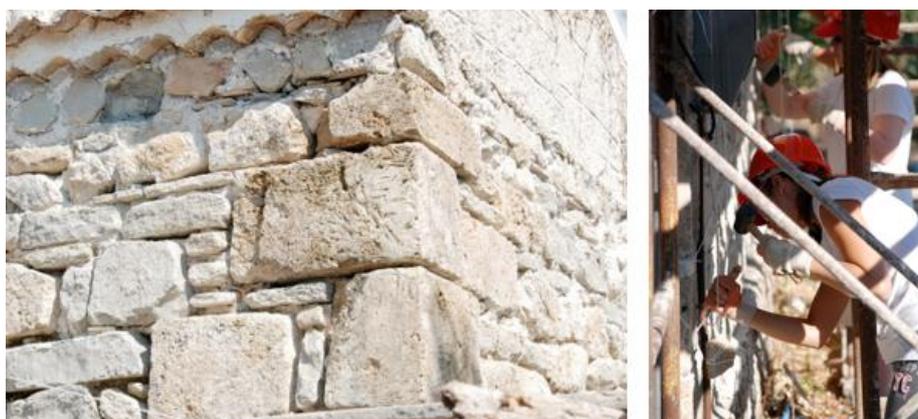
Remoção dos rejuntas de cimento aplicados.
